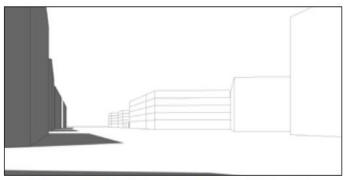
Variante 3, Perspektive Straßenraum, Blick nach Norden (1)
